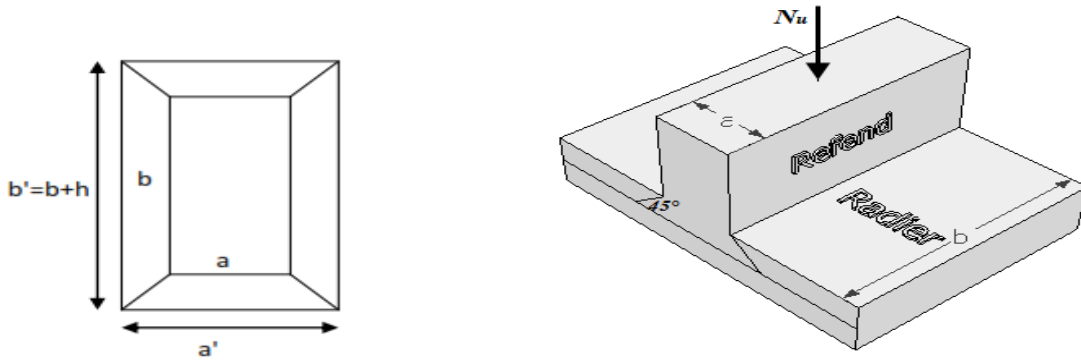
Périmètre utile des voiles et des poteaux.
